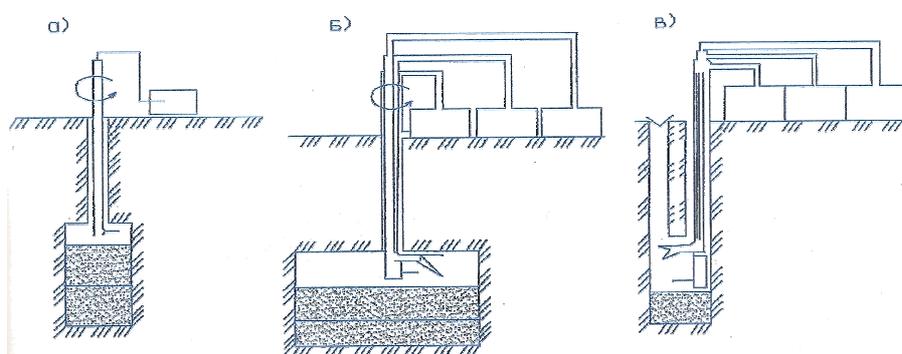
Водовоздушный метод уплотнения грунтов оснований
